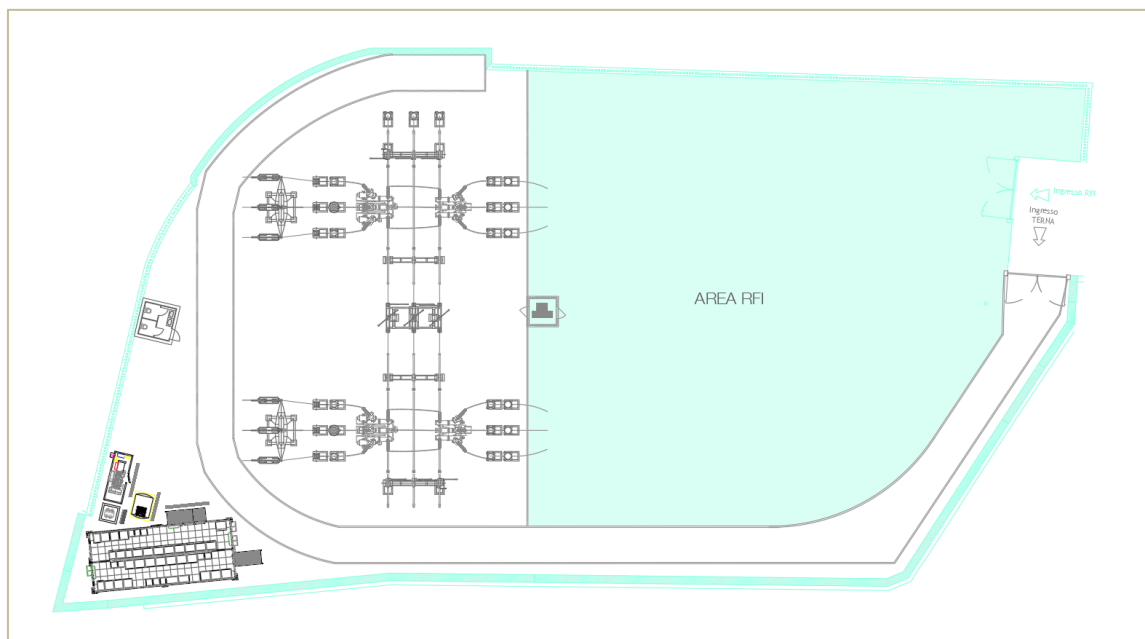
Planimetria elettromeccanica della nuova SE Cefalù.
